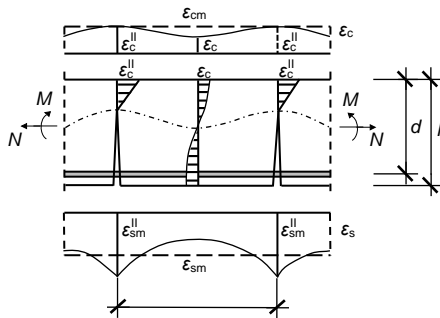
Beton- und Stahldehnungen längs eines biegebeanspruchten Stahlbetonbalkens nach *Fastabend 2002
